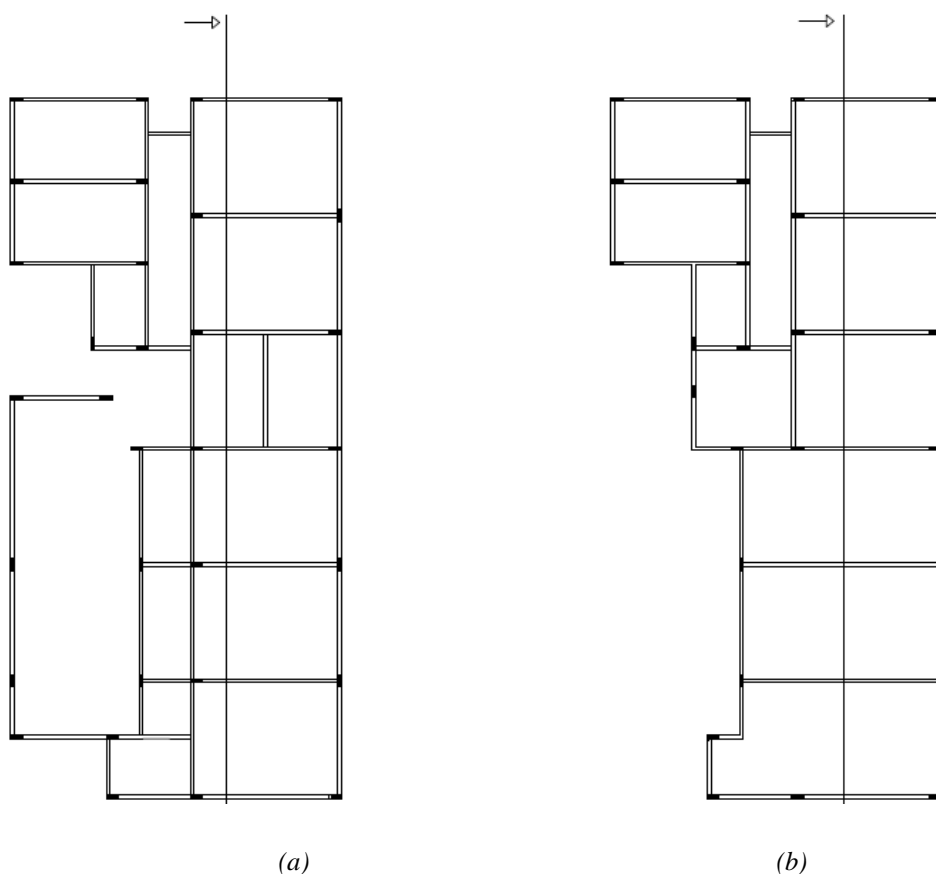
Esboço da estrutura do anexo A (a) 1º pavimento (b) 2º pavimento
